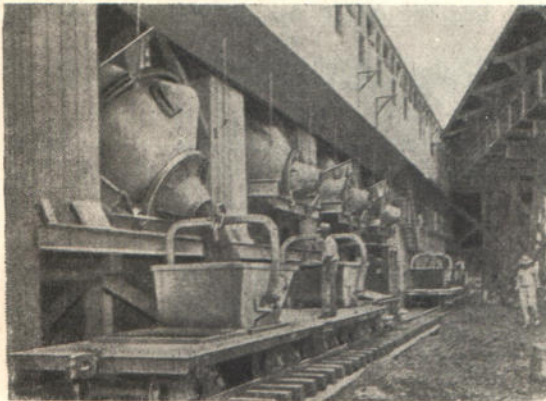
Нижній этажъ главнаго бетоннаго завода въ Гатунѣ; выгрузка бетона.
